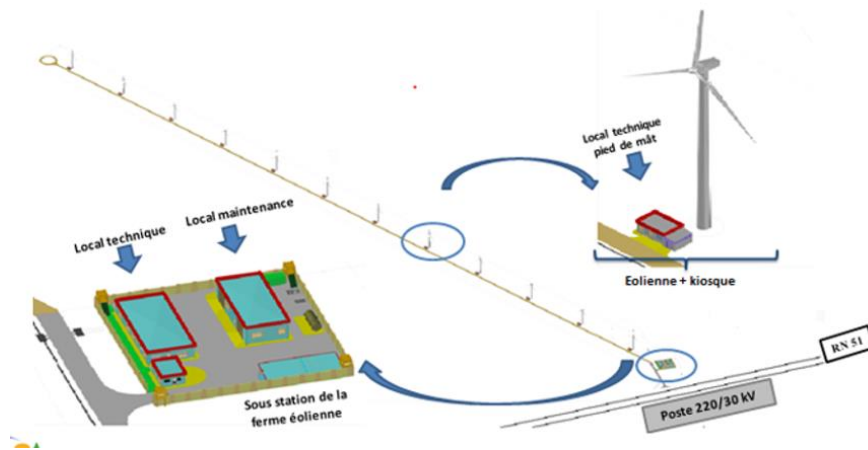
Plan d'implantation de la ferme éolienne de Kabertène [46]
